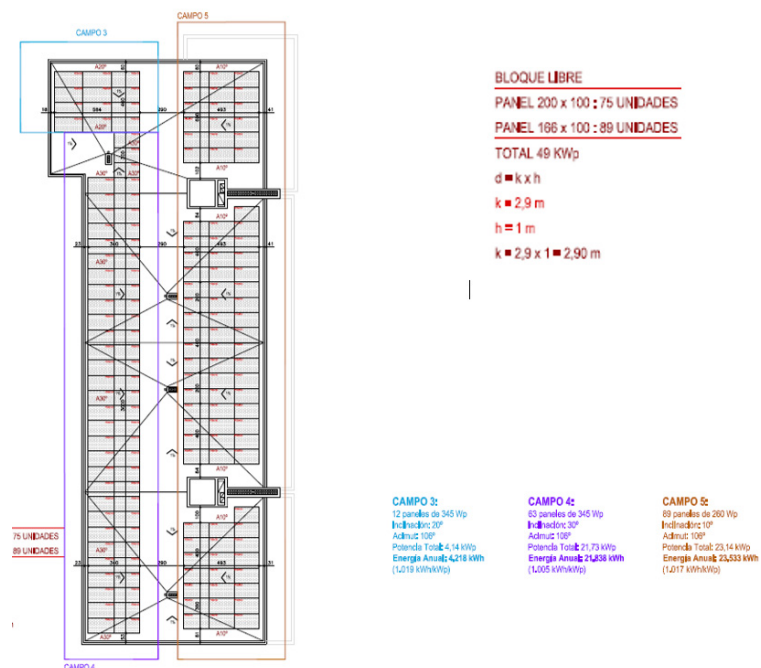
Instalación fotovoltaica en cubierta edificio viviendas libres.
